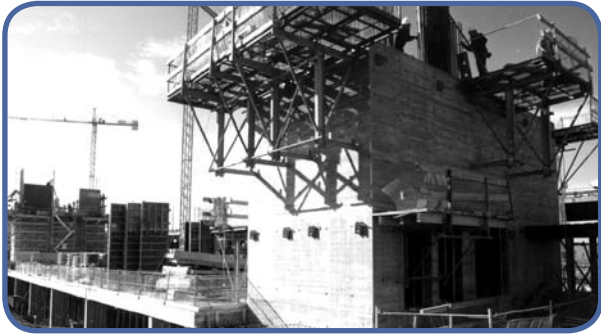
Construcción de los núcleos verticales mediante encofrado trepante
